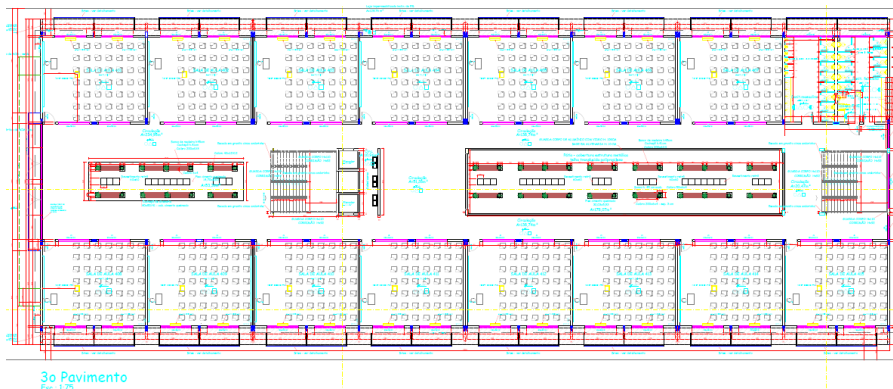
Projeto executivo, terceiro pavimento – Bloco VI.
